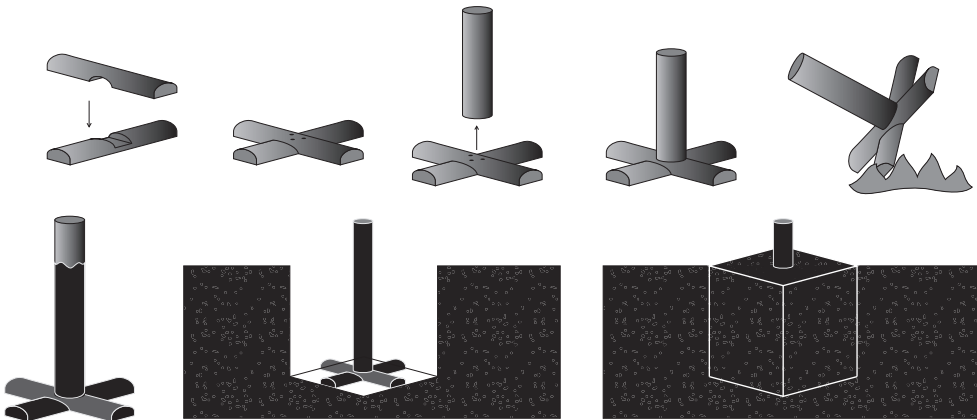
Создание бревенчатого столбчатого фундамента
